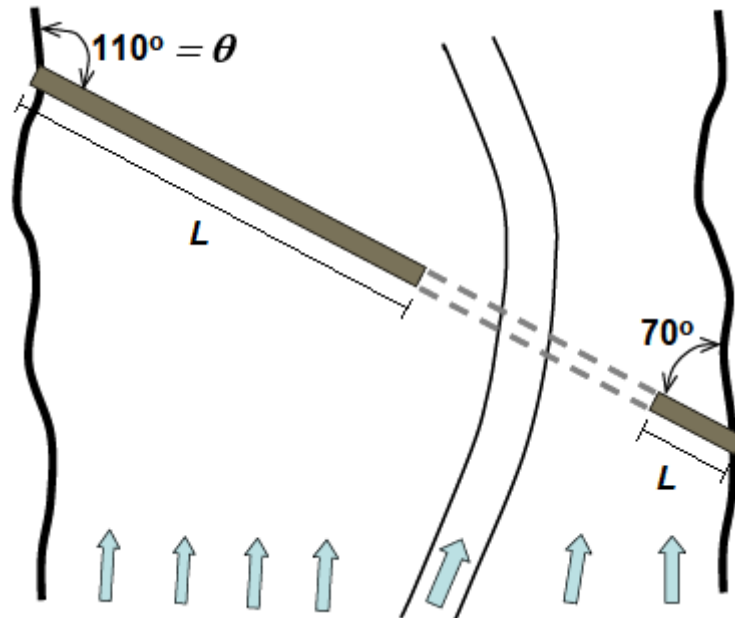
Calcolo dello scalzamento in corrispondenza delle spalle.
